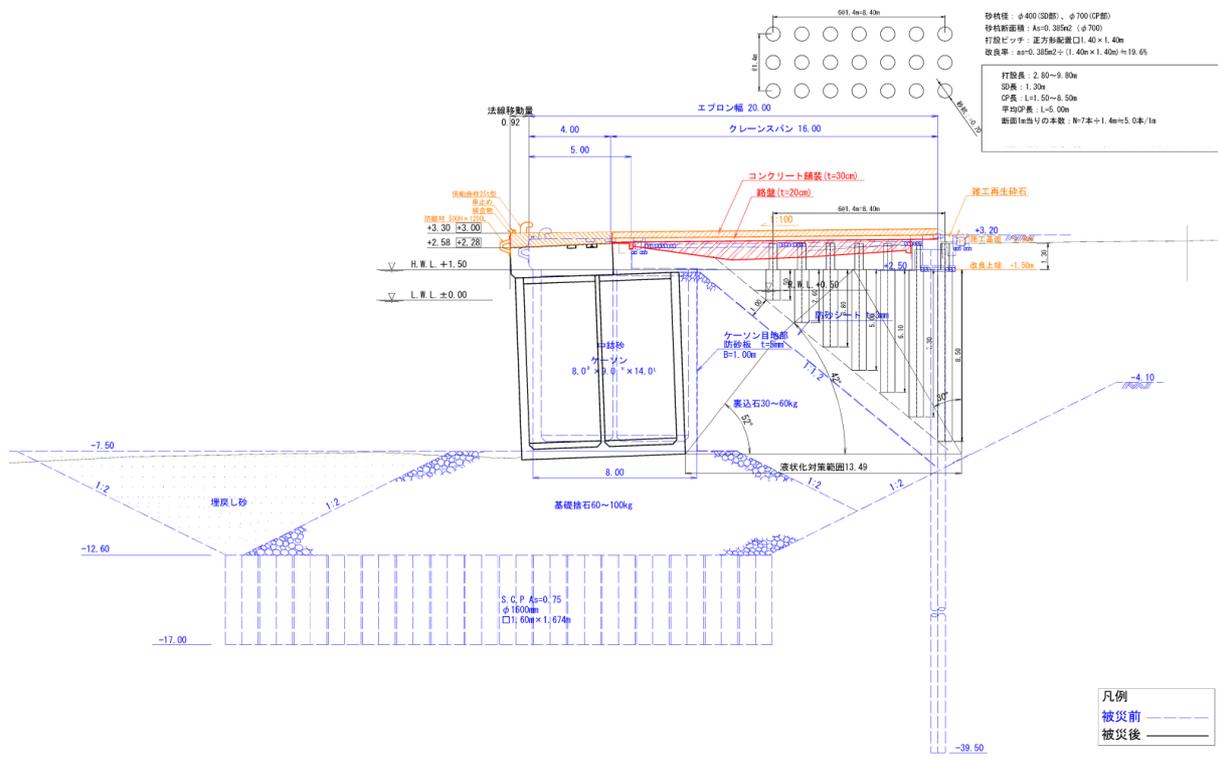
No.9 日立港区_第4ふ頭地区 4-C岸壁 (-7.5m) の断面図 (復旧後)
